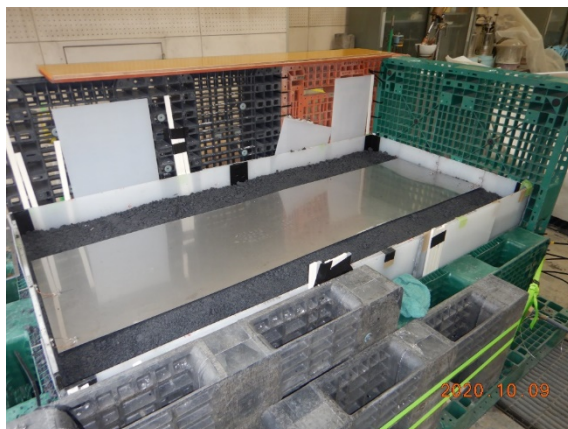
上層路盤 (粒度調整碎石) 施工
